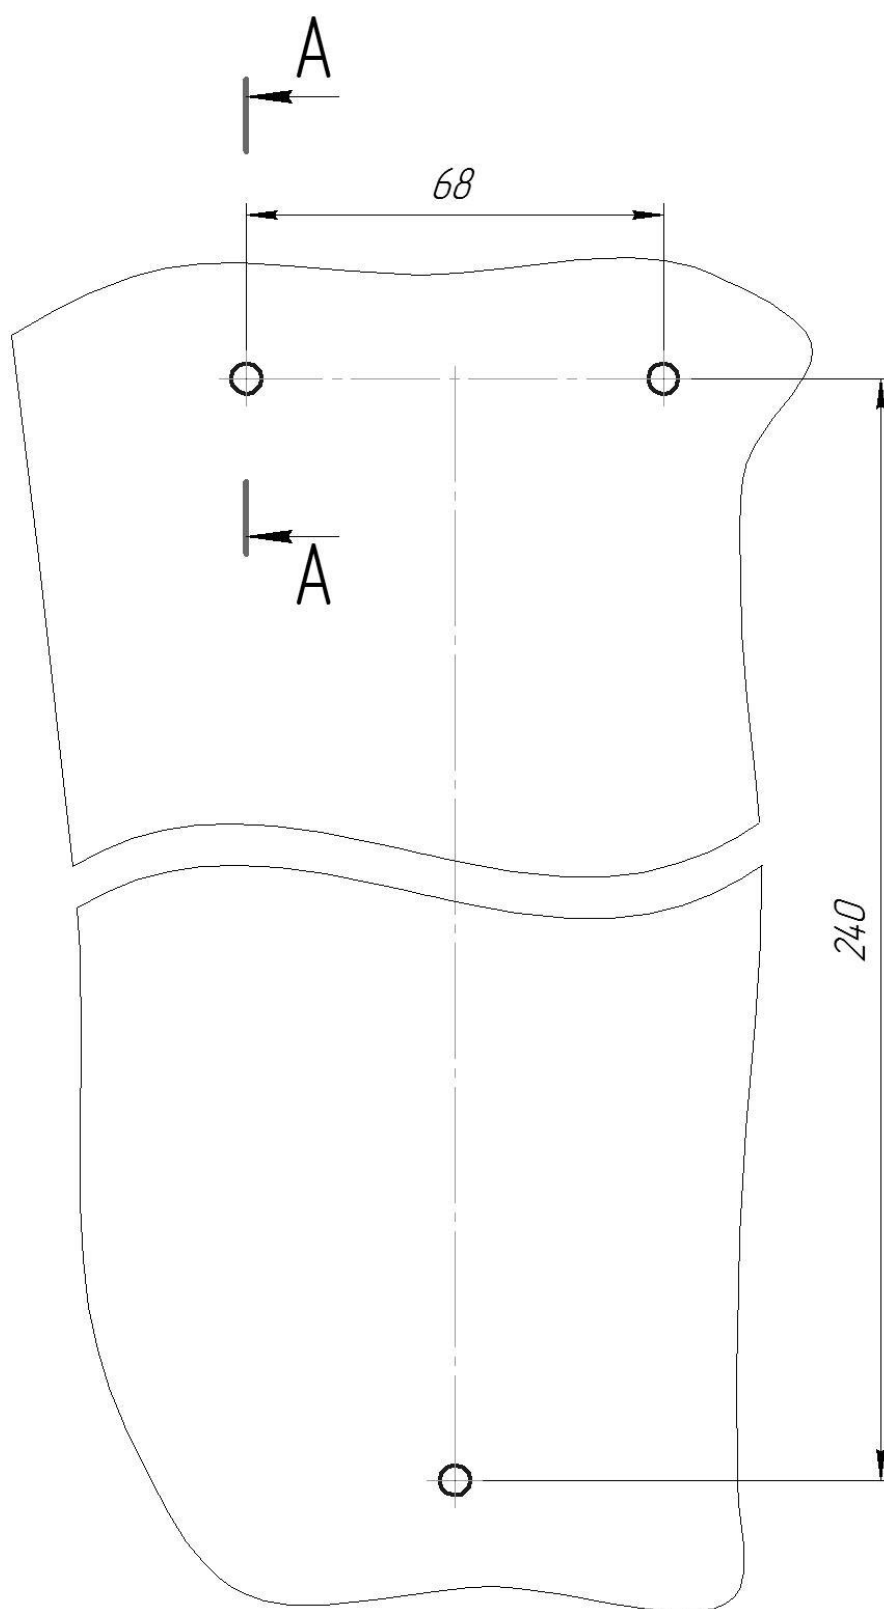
Разметка отверстий для крепления блока БПР-12М
